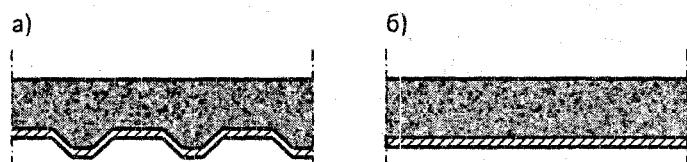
Поперечні перерізи сталезалізобетонних плит:
